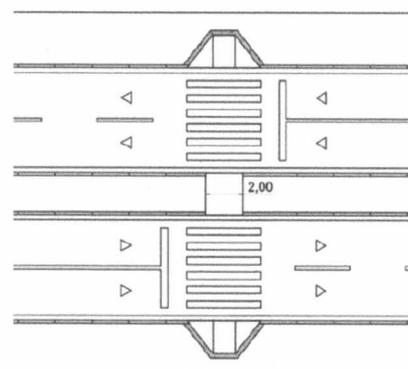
Canteiro divisor de pistas - Exemplo 1
